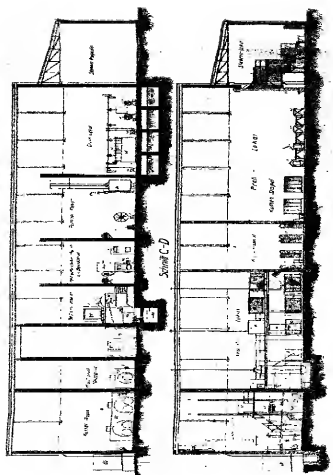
u. 18. Längsschnitte zu dem Grundriss Fig. 96. (Verkleinerte Maßstabe)
